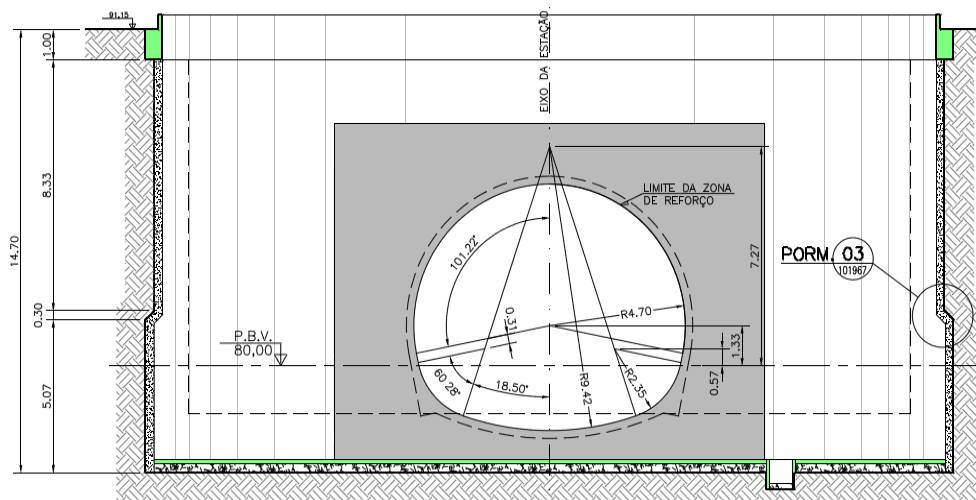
Alçado do reforço do emboquilhamento do túnel norte (Adaptado CJC, 2008).
